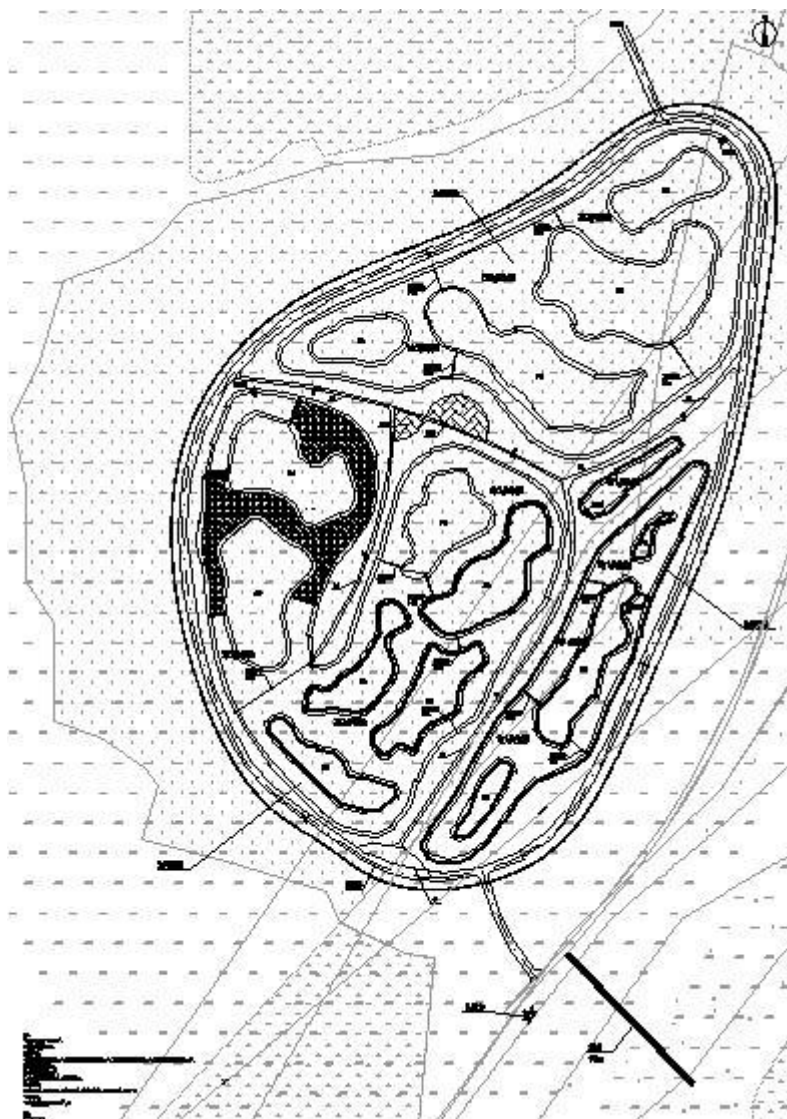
冬至河红崖堡水生态修复区平面布置图
